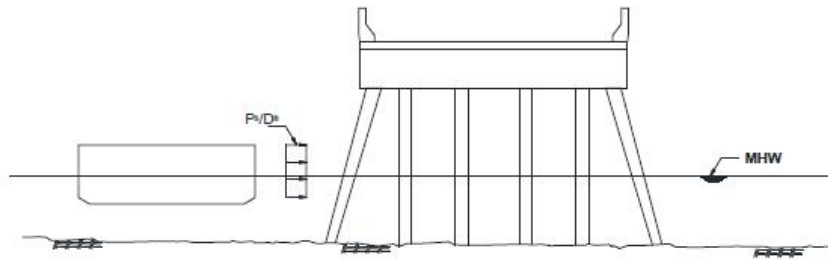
Beban dampak kapal terbagi merata untuk gaya dampak lokal pada pilar (untuk desain dan memeriksa struktur)
